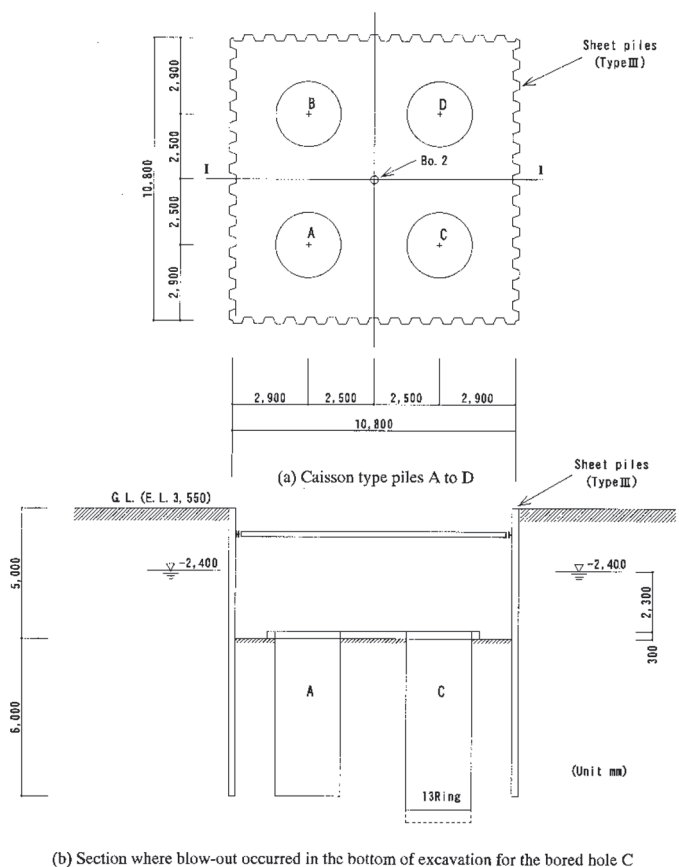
K 線高架橋平面図及び掘削断面図 (P₂ 橋脚) (永井ら, 2016c)
